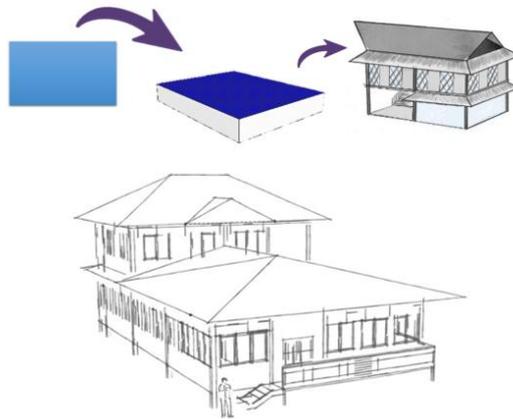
Konsep Konfigurasi Geometrik Massa Bangunan Indoor Exhibition
